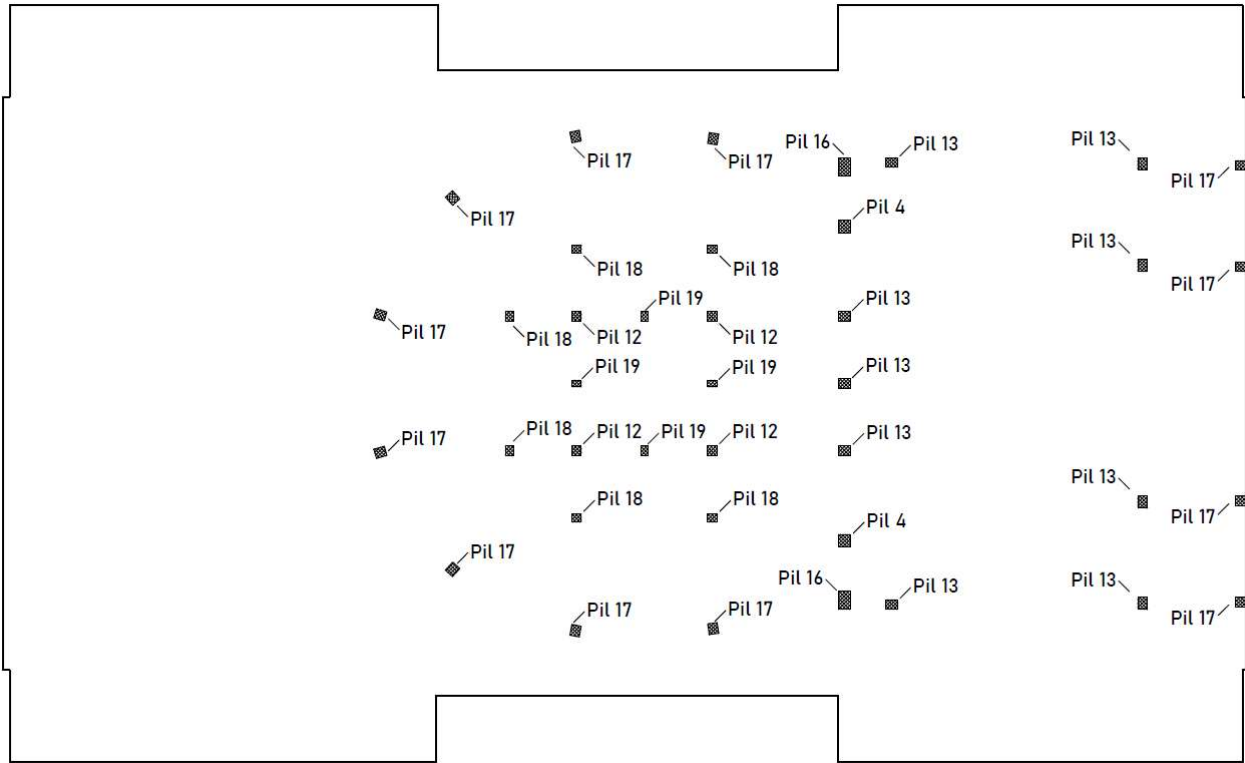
Pianta pilastri piano lucernario, si nota la presenza dei pilastri della struttura portante del tetto sulla platea
